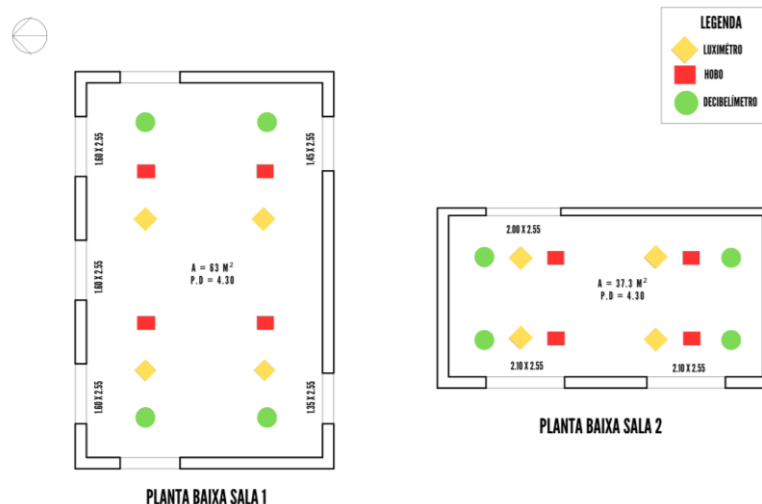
Planta Baixa com legenda com a posição dos aparelhos. Fonte: os autores.
